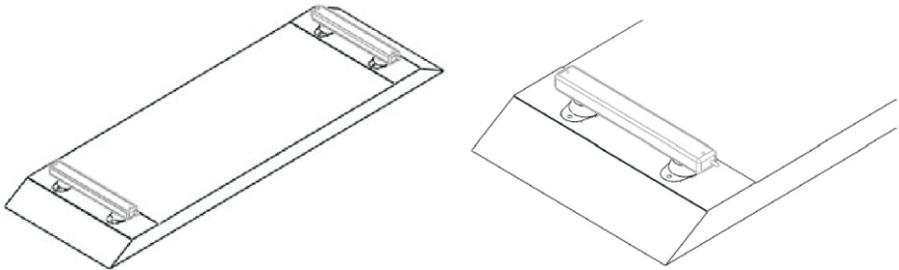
Apoio das sapatas em base de concreto para fixação da plataforma.
